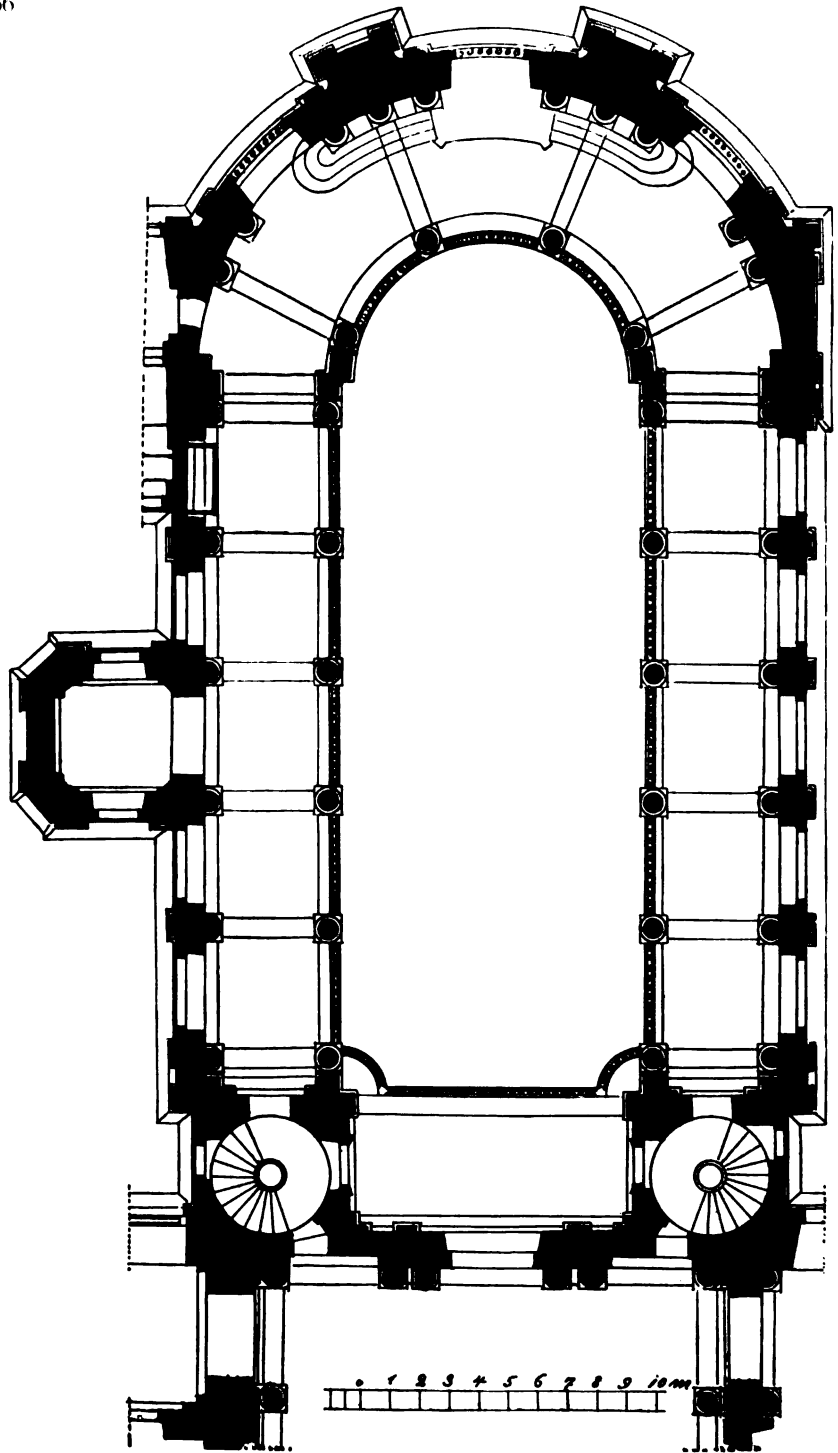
Kapelle von Versailles. Grundriss.
